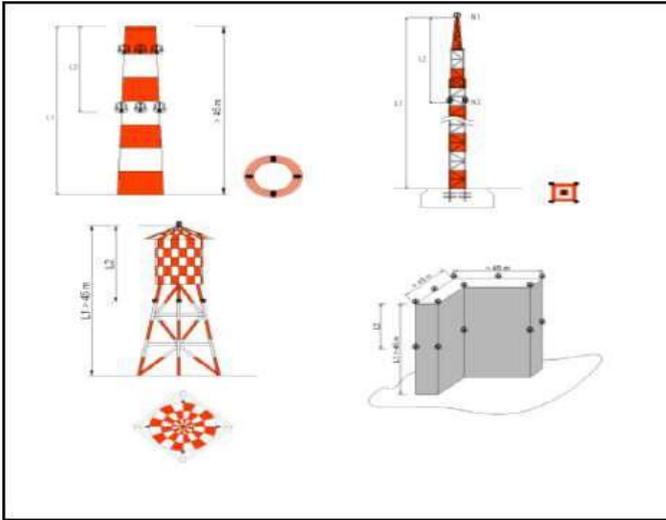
Ejemplos de iluminación de obstáculos/estructuras >45m
